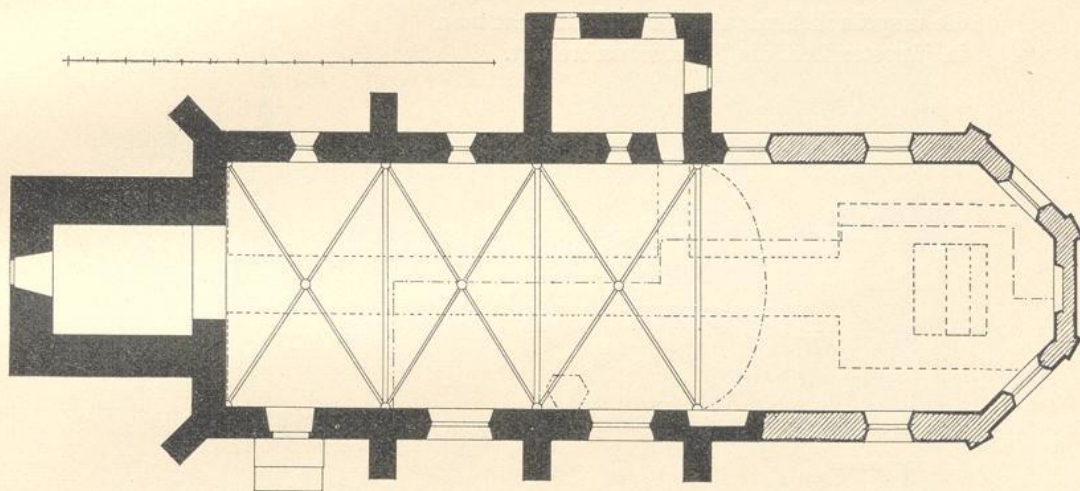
Kirche in Gehrde; Grundriß (1:250).
